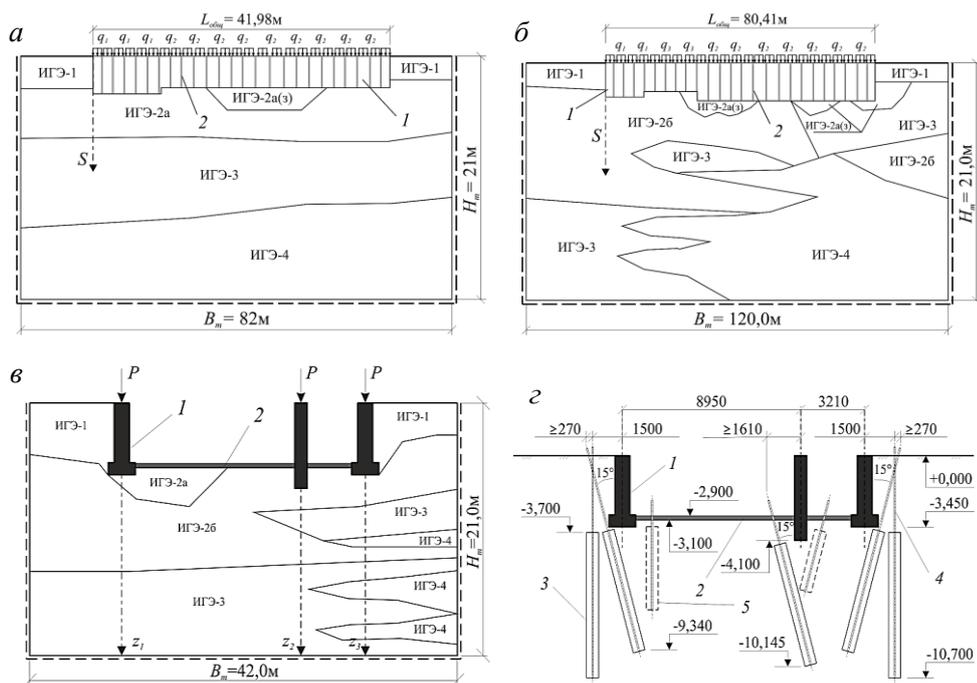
Схемы продольных базовых моделей вдоль западного (а) и северного (б) фасадов здания, поперечной локальной модели (в) и схема закрепления грунтов основания (г):
